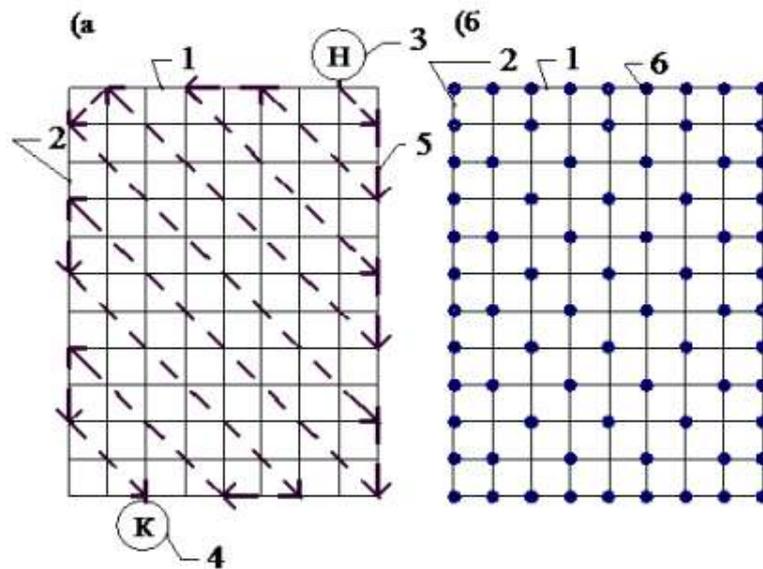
Порядок закрепления арматурных стержней вязальной проволокой: а) схема движения рабочего вязущего пересечения стержней; б) схема закрепления стержней арматурной сетки: 1- поперечные стержни; 2 – продольные стержни; 3 – начало пути рабочего; 4 – окончание пути рабочего; 5-путь движения рабочего; 6 – пересечение арматурных стержней, закрепленное вязальной проволокой
